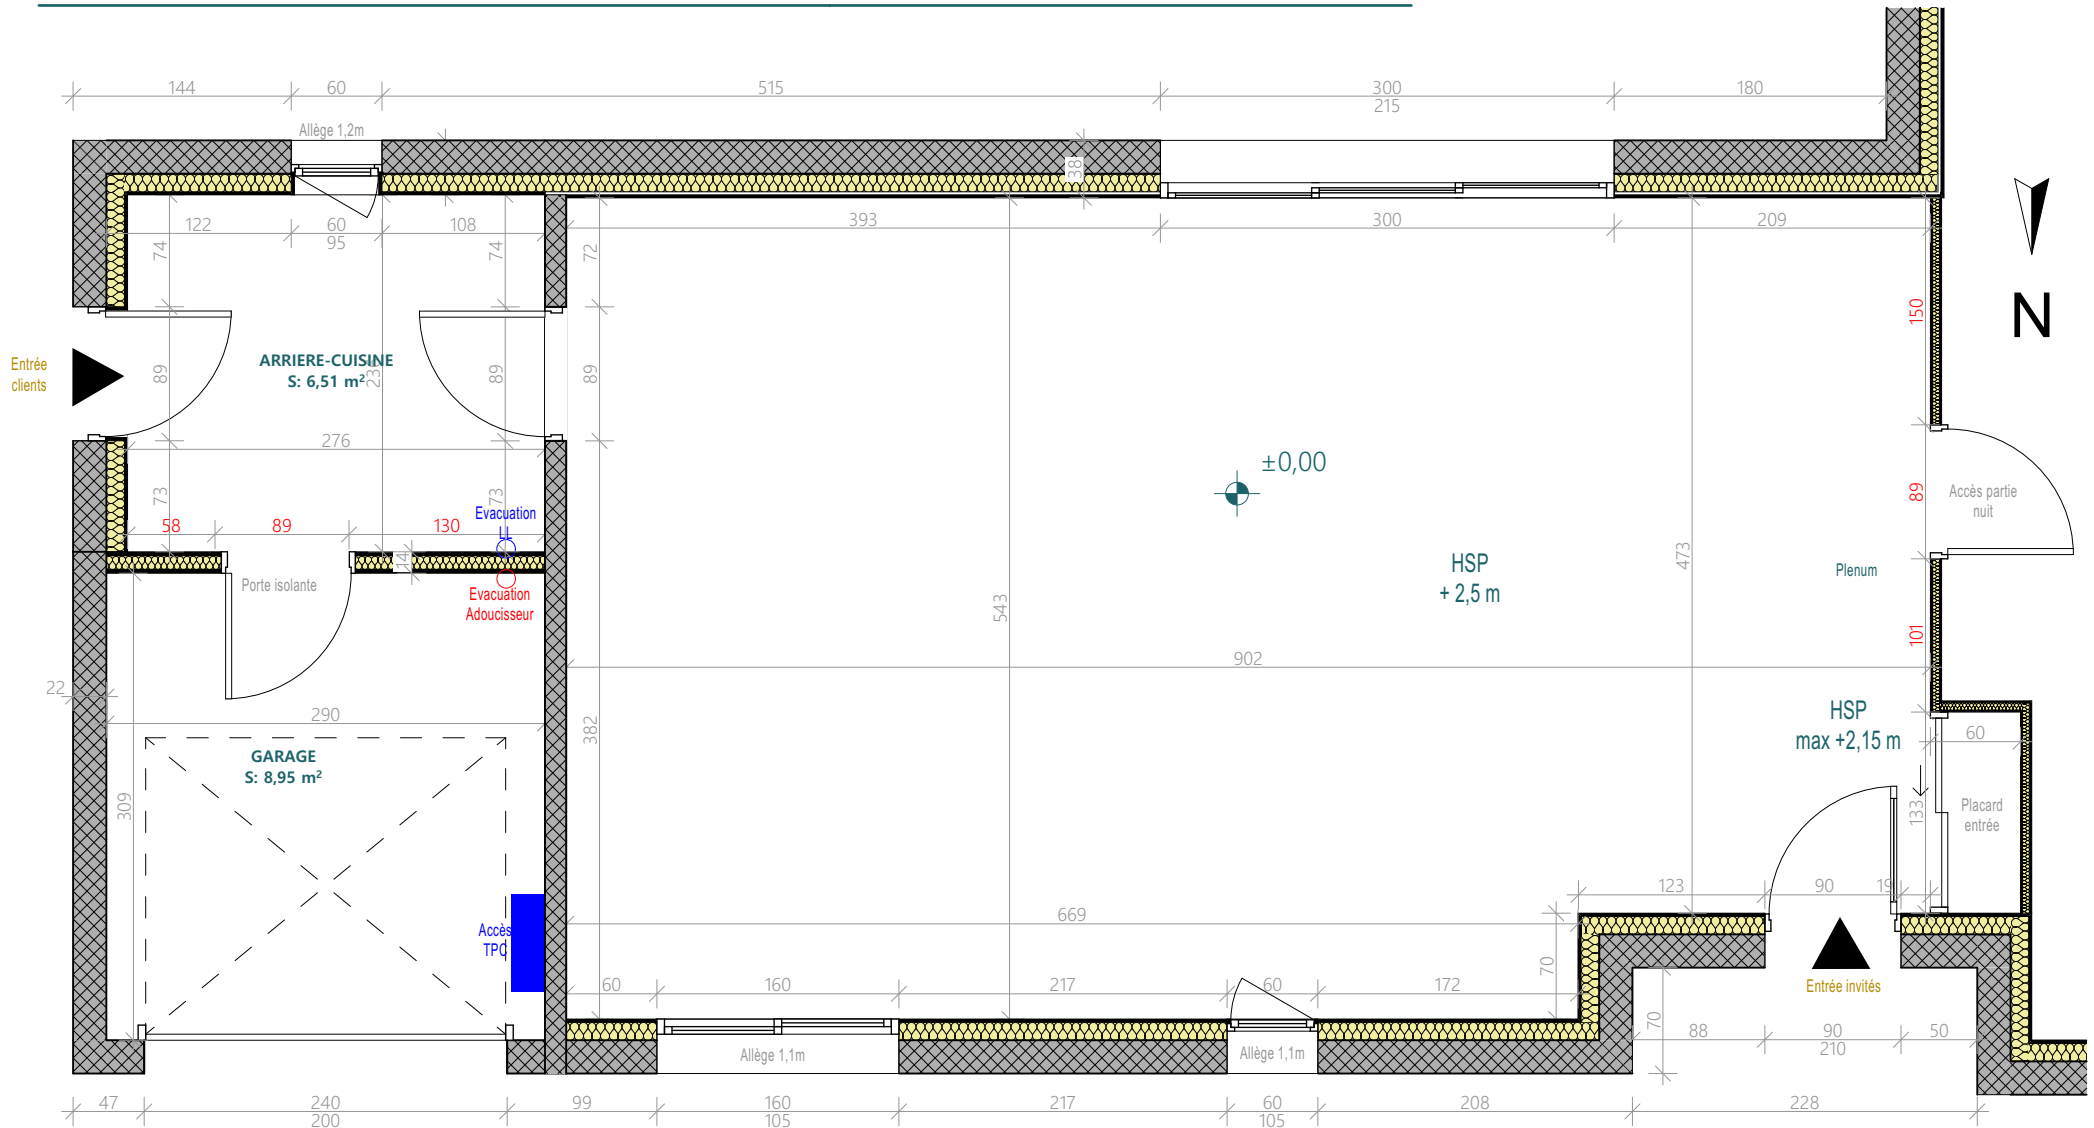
PHOTO DU PLAN D'ORIGINE DU CONSTRUCTEUR
